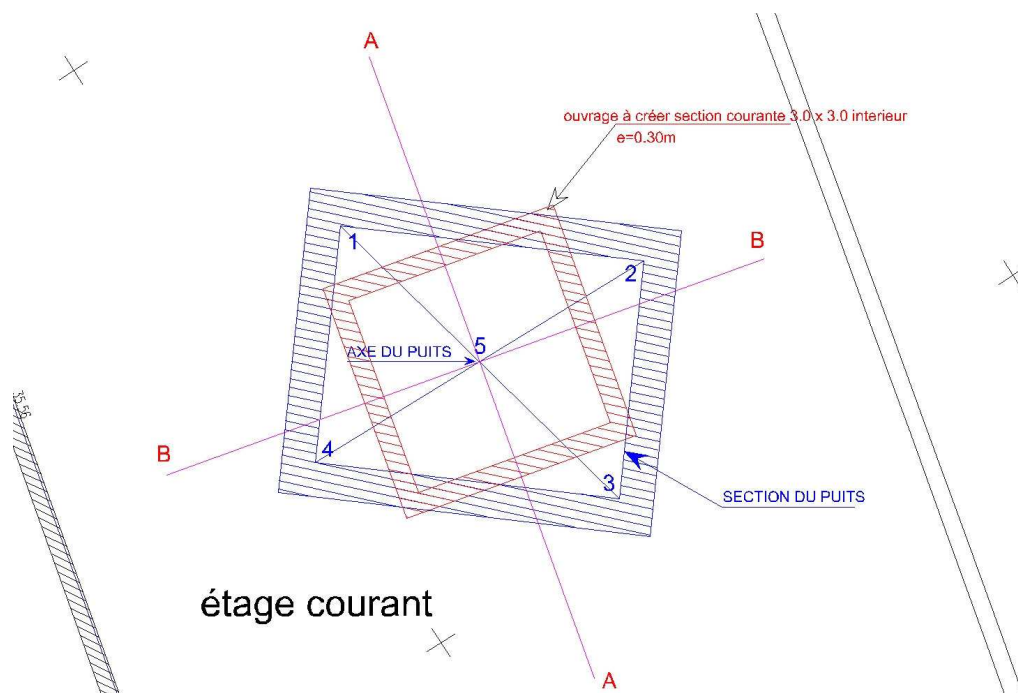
Vue en plan des ouvrages à réaliser au niveau d'un étage courant
